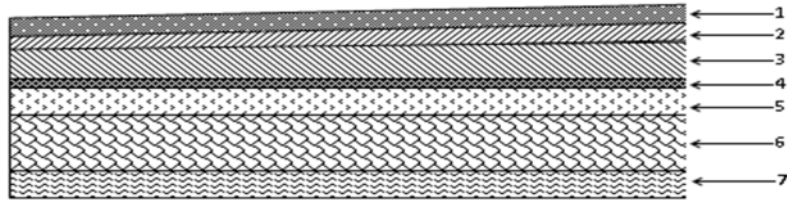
Coupe transversale du plancher terrasse inaccessible.
